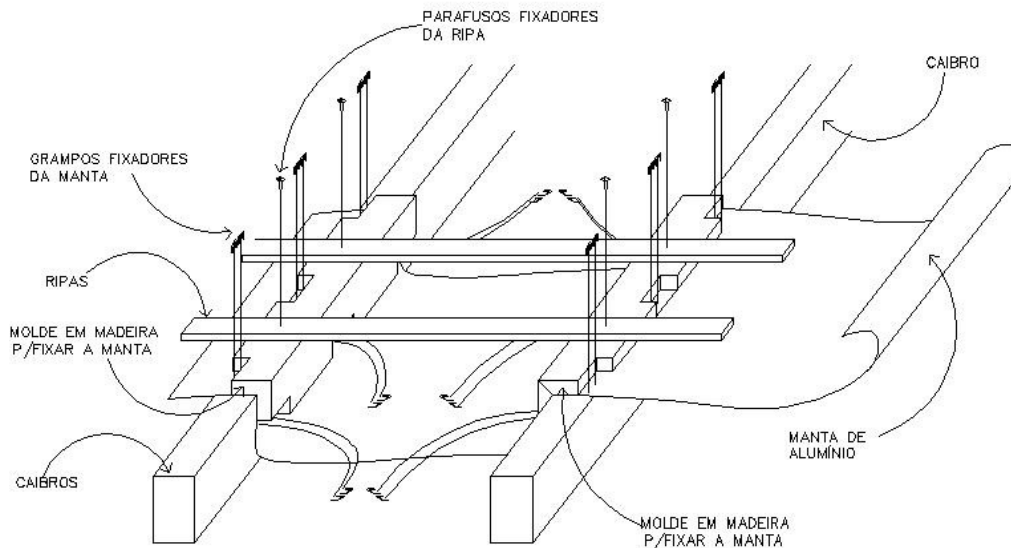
Exemplo de detalhamento executivo da manta de proteção do madeiramento do telhado desenvolvido na fase executiva do projeto de restauração. Projeto de restauração da garagem da Casa de Rui Barbosa. Fonte: Arquivo Bk Arquitetos Associados Ltda.
